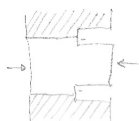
Boceto en planta de la geometría de la construcción situada en la Rúa Celso Rivas Perez, nº 7 (autoría propia).
